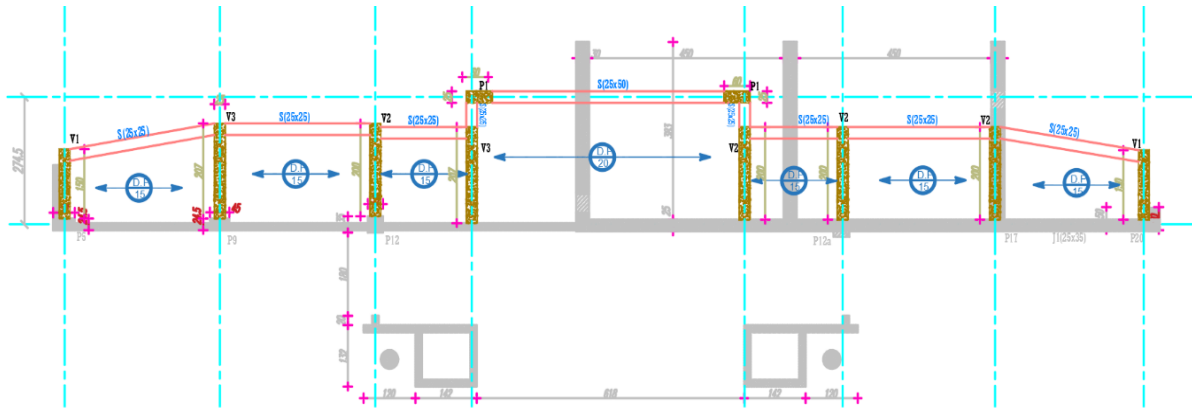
Vue en plan du PH RDC de la façade renforcé en béton armé
